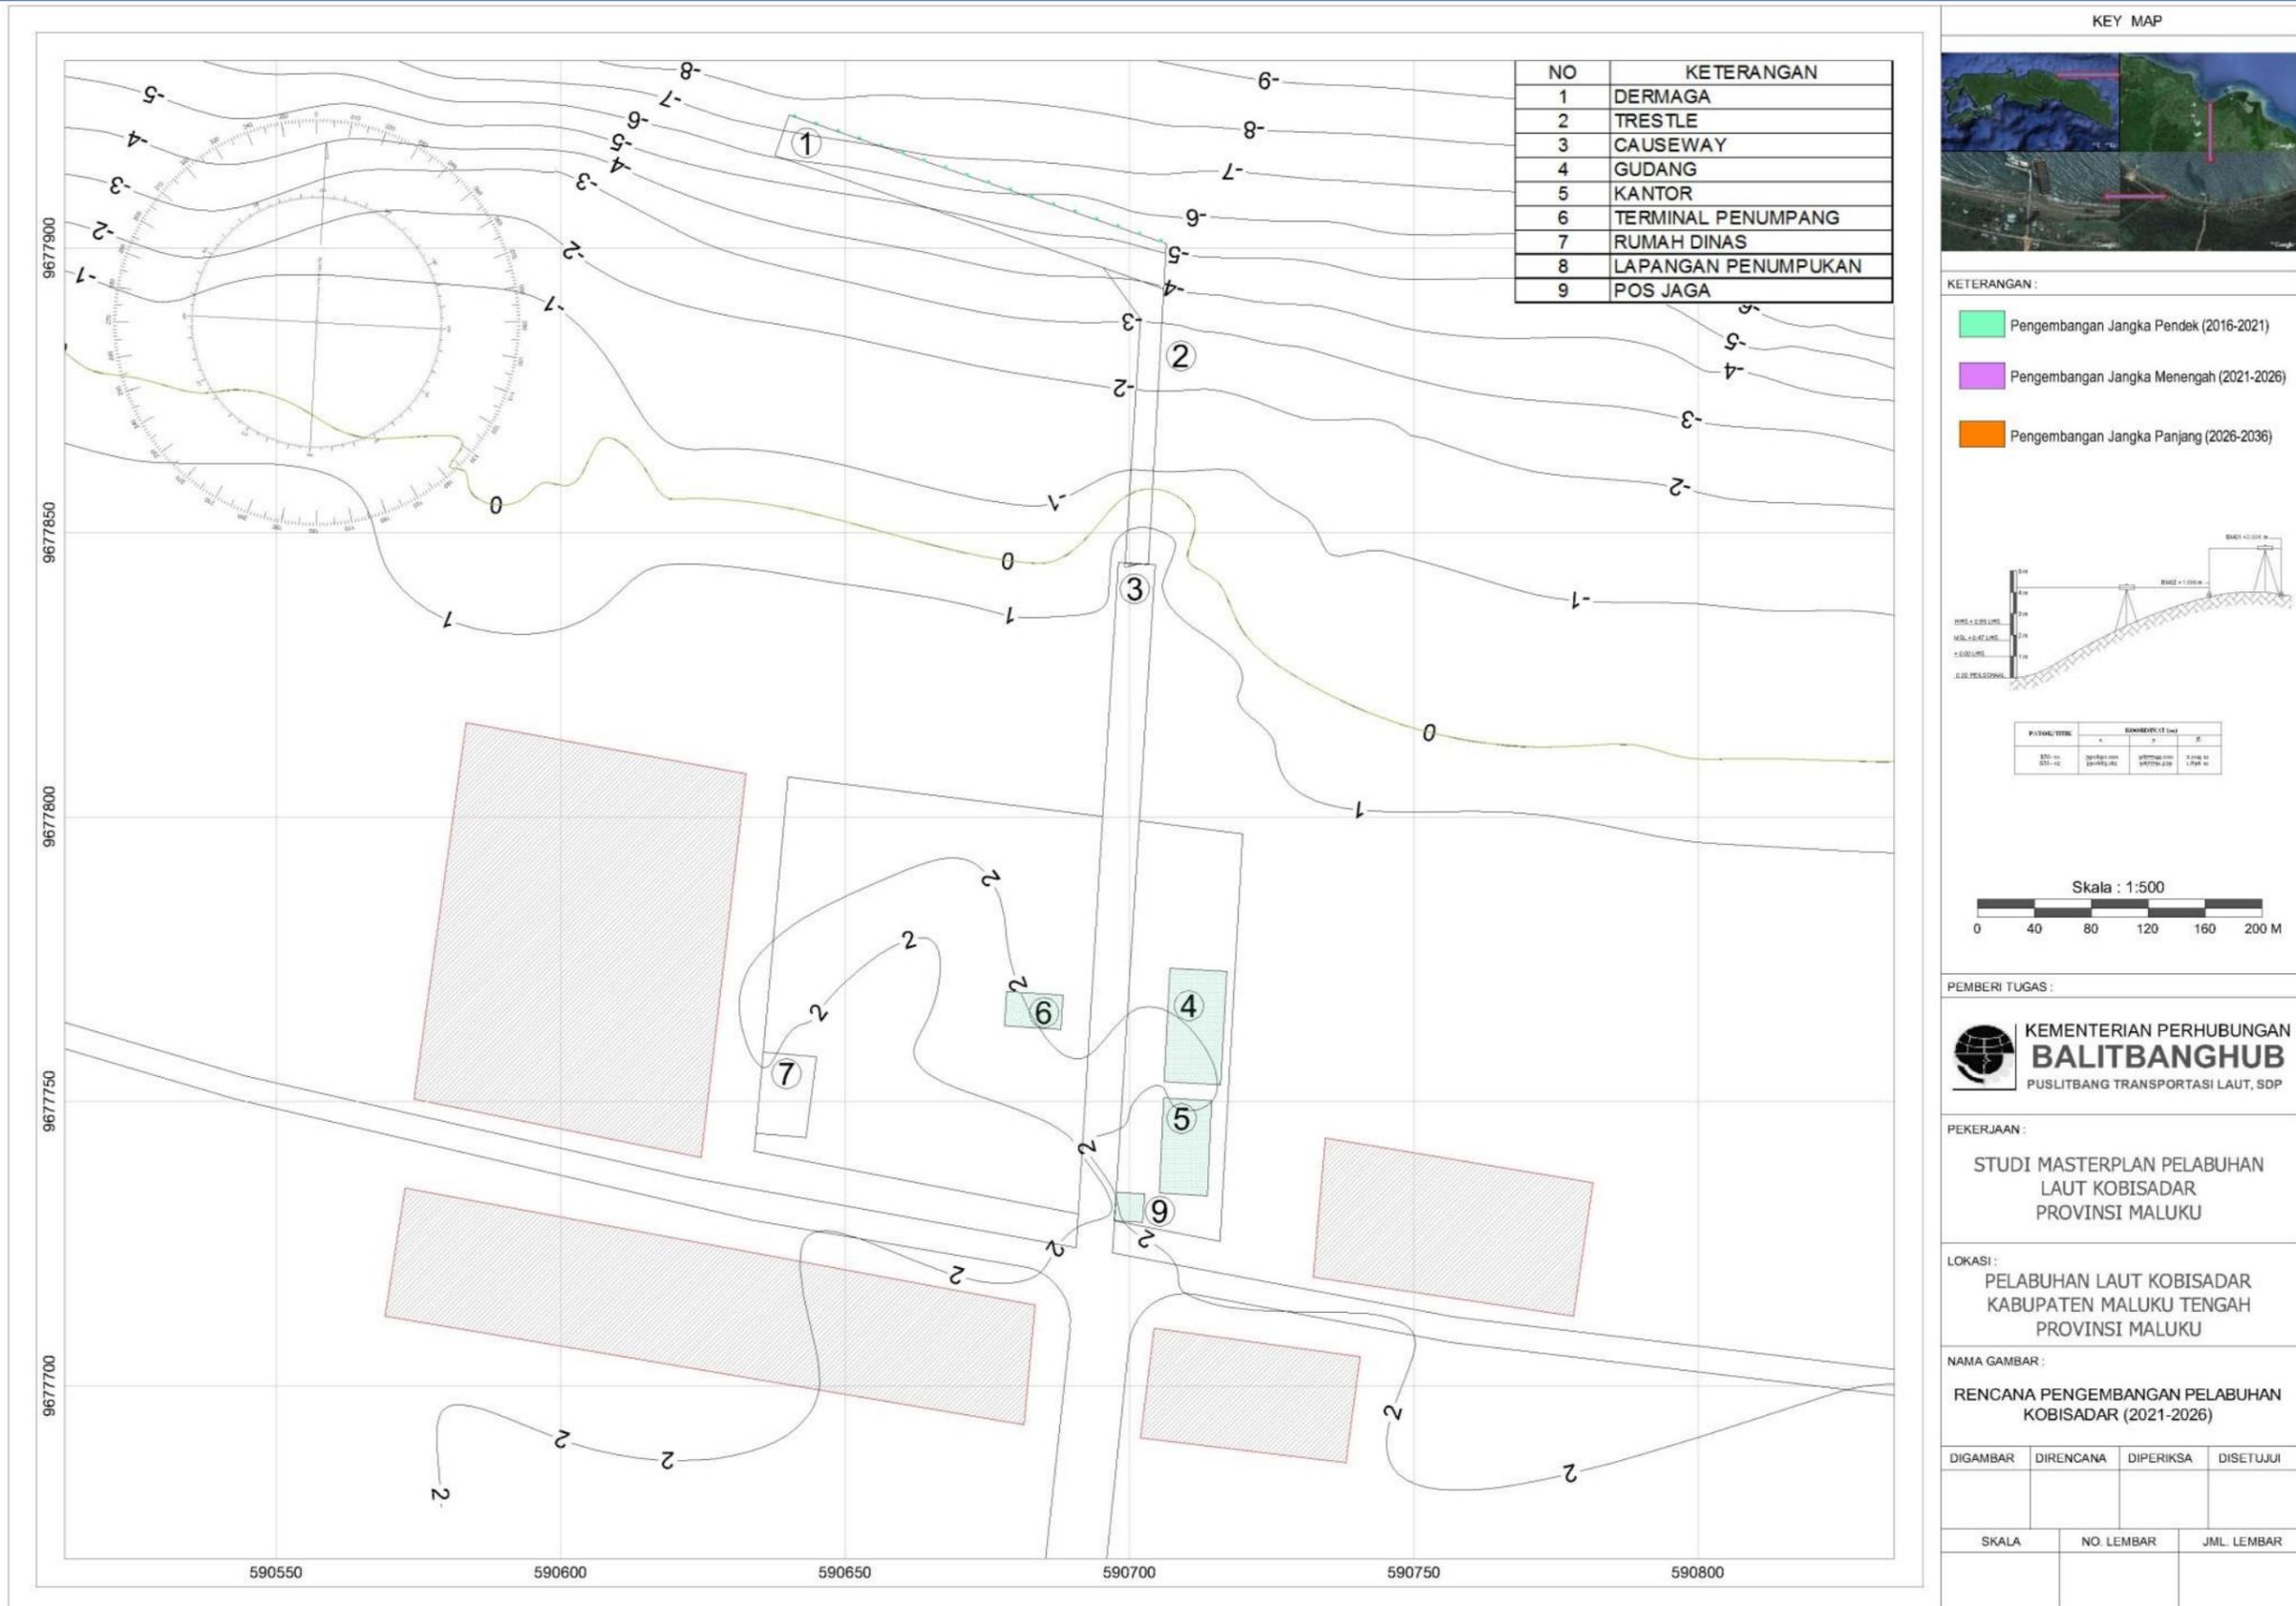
Layout Eksisting Pelabuhan Kobisadar
